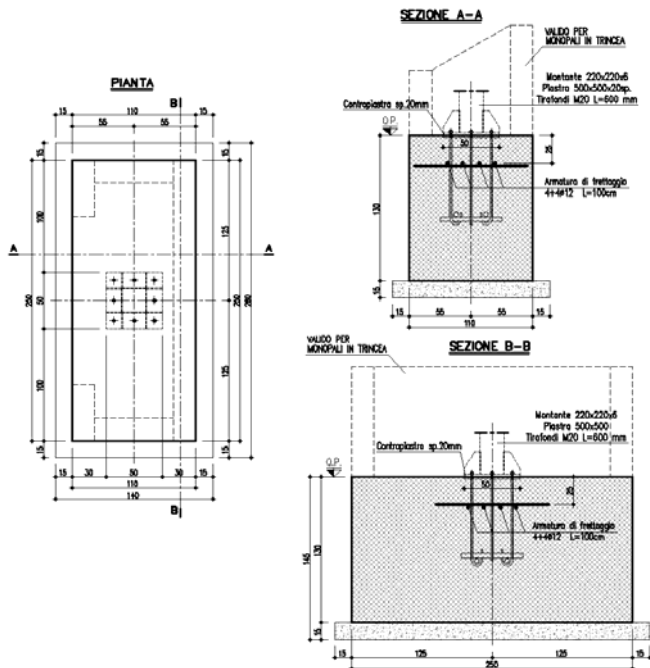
Caratteristiche dell'ancoraggio alla fondazione
